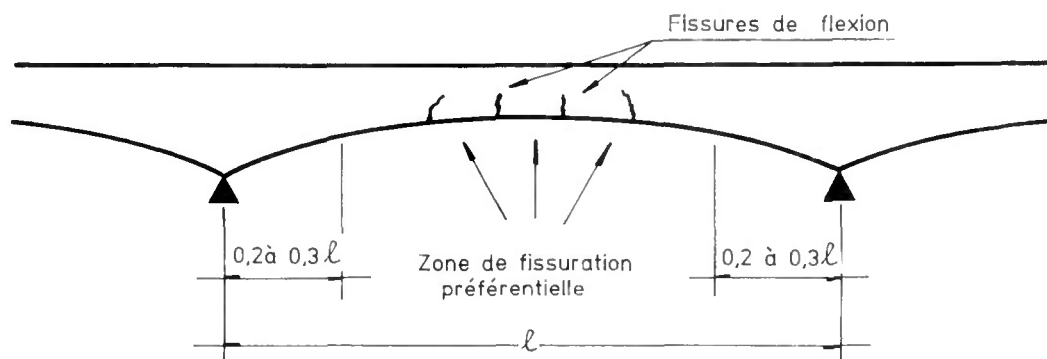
Zone préférentielle de fissuration à la flexion.
